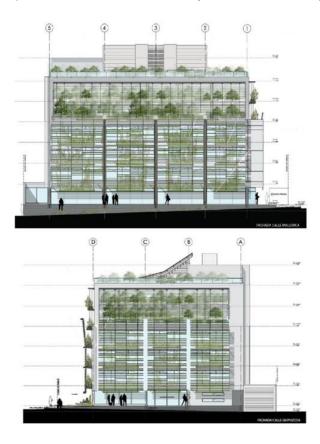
Fachada Guip Uzcoa y Fachada Mall Orca. Fuente: Quito Publishing House. Estudio A0, Quito, 2014, Sebastián Crespo, Jean-Claude Constant (https://archdaily.com)
